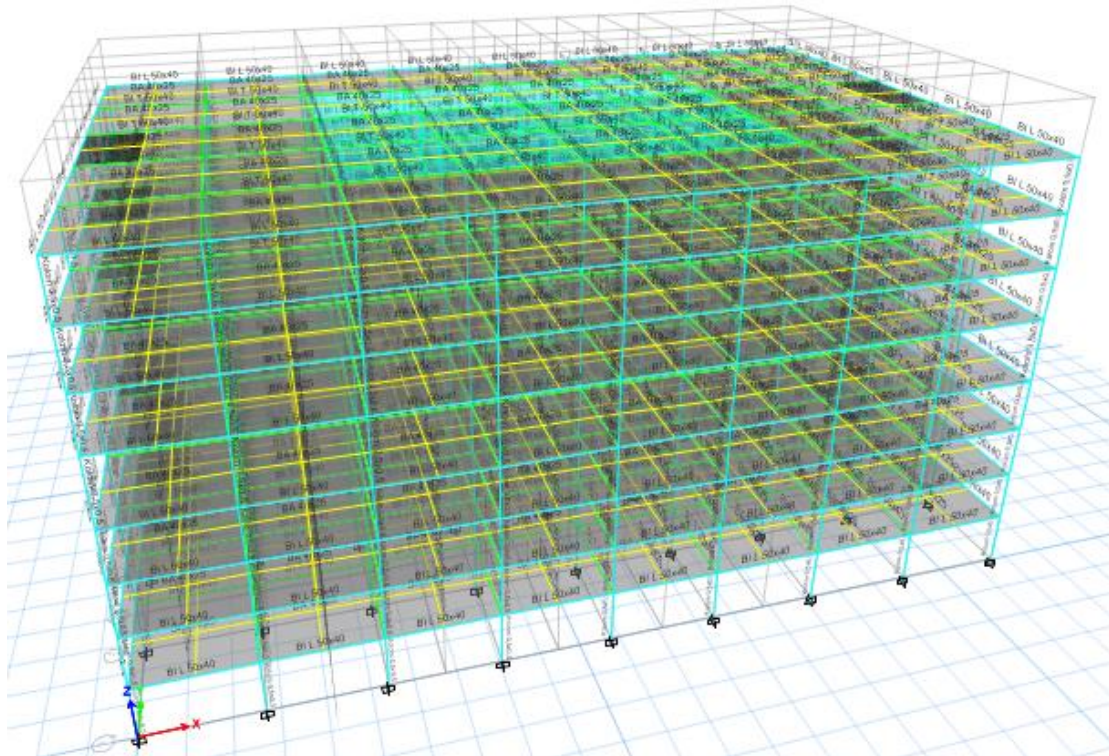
Denah Model 2 Lantai 1 – Lantai 7 dengan *Seaworld* di Lantai 8
